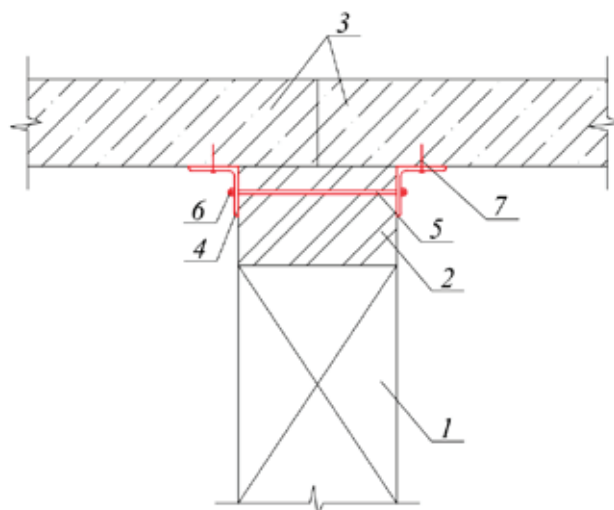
Усиление внутренней стены: 1 — внутренняя стена ФБС; 2 — усиливаемая кирпичная кладка; 3 — плиты перекрытия; 4 — металлический уголок; 5 — шпилька; 6 — стяжной болт; 7 — дюбель
